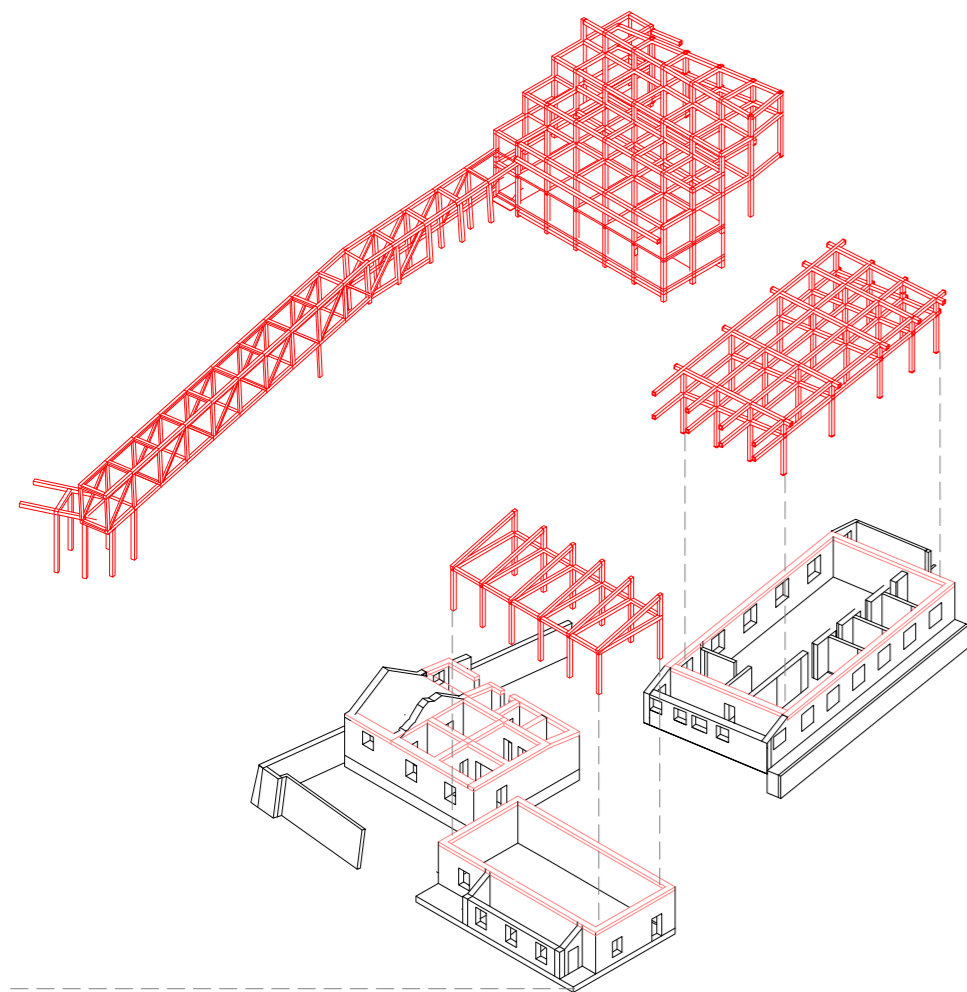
Estructura independiente y complementaria. Uso de cadenas de hormigón para consolidar la preexistencia.
